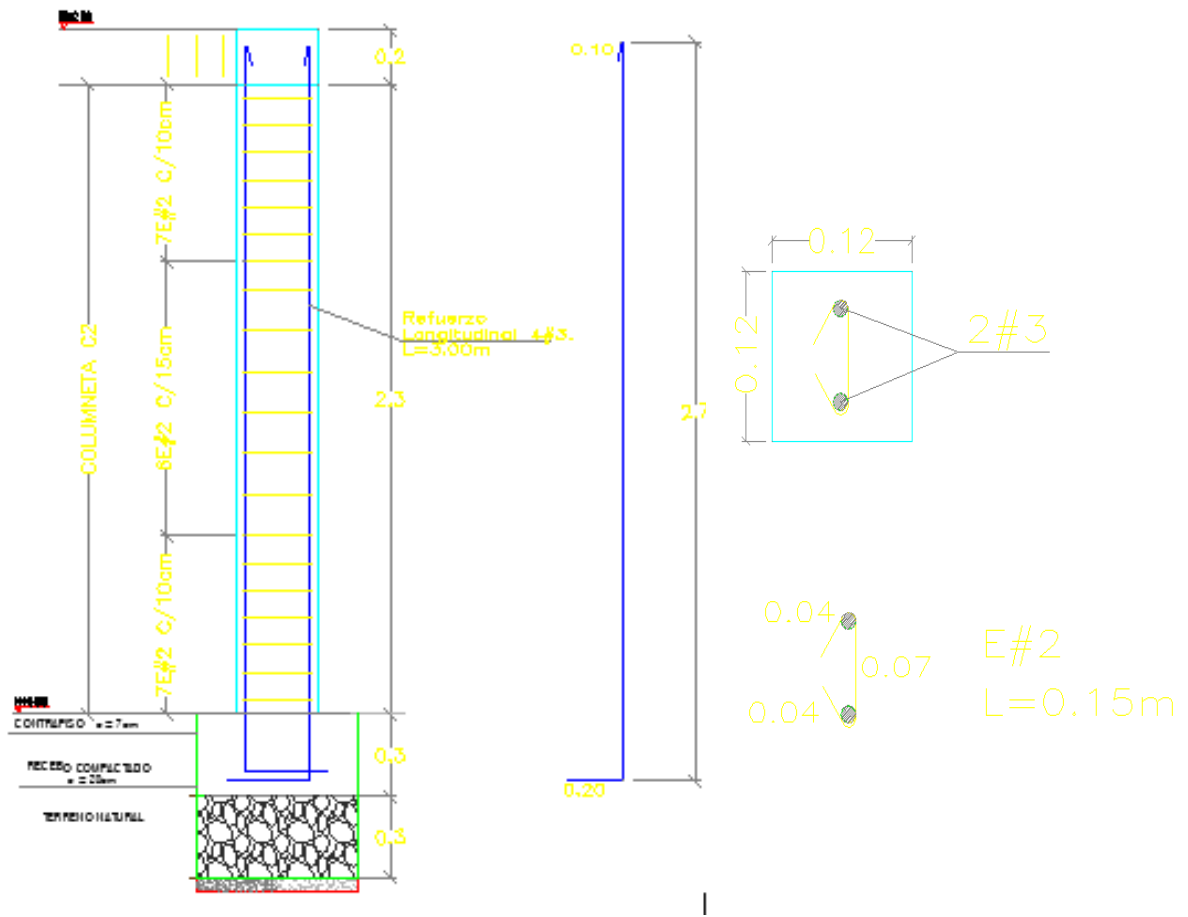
Columnetas tipo 2 AUTOCAD.
